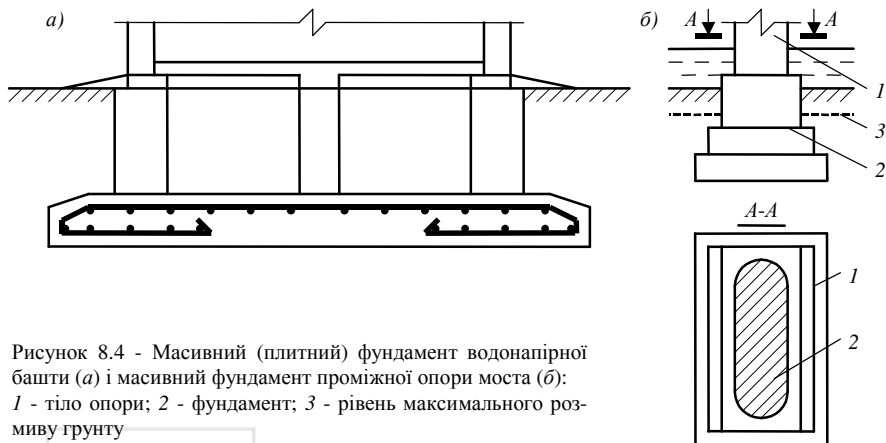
Масивний (плитний) фундамент водонапірної башти (а) і масивний фундамент проміжної опори моста (б):
